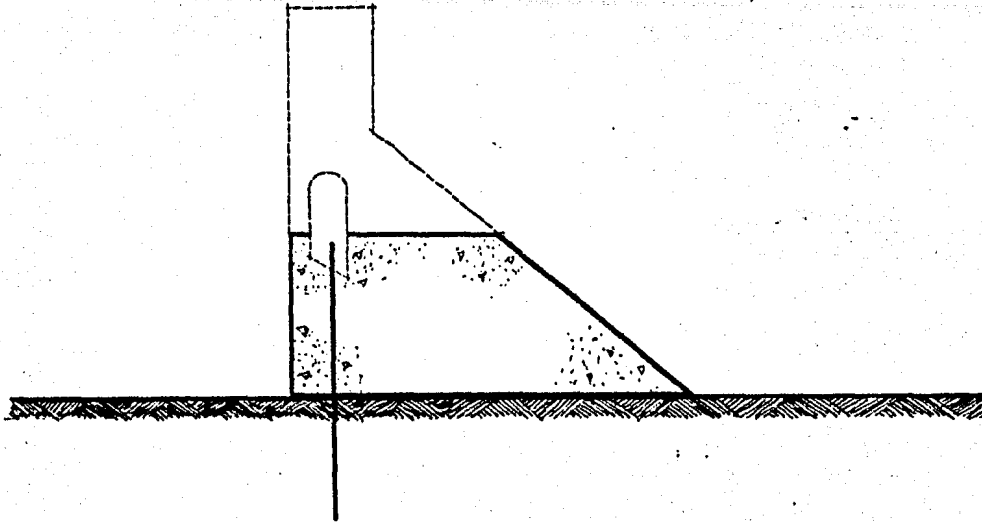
Inyección desde la galería de la presa parcialmente construida.
